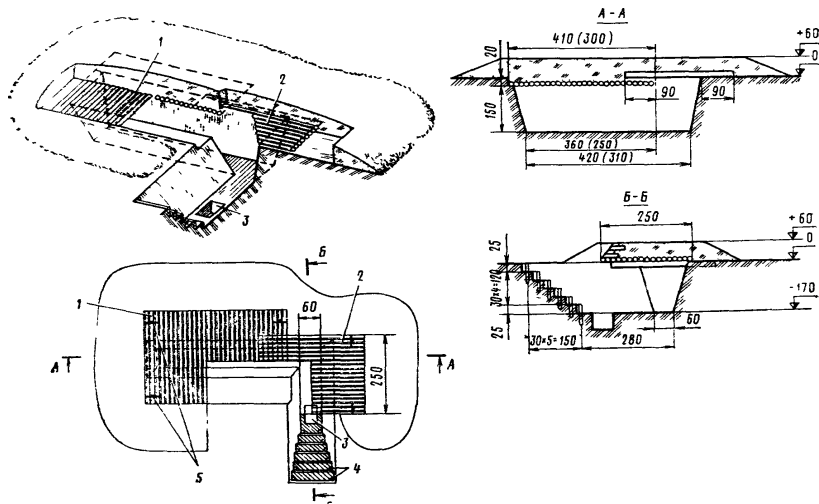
Перекрита щілина на відділення (екіпаж, обслугову):
